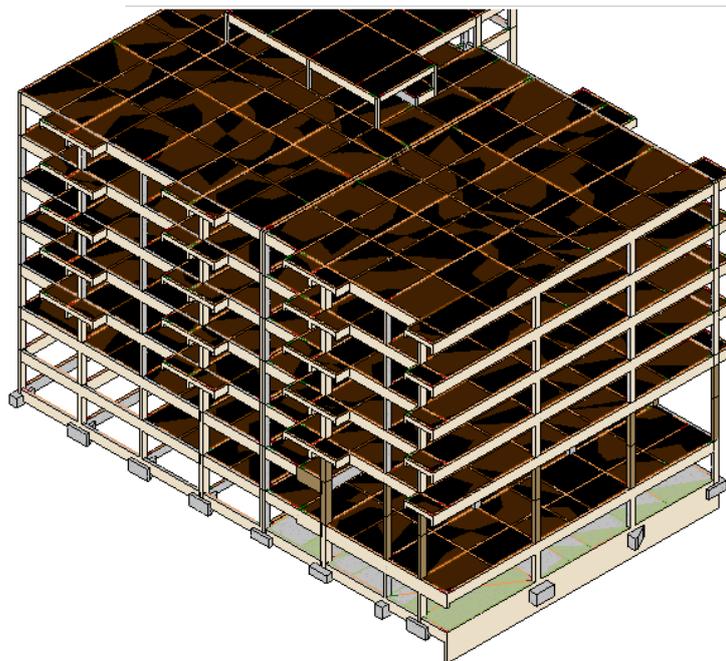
Modelo 3D do projeto estrutural. No projeto estrutural não foram previstas as varandas frontais.
